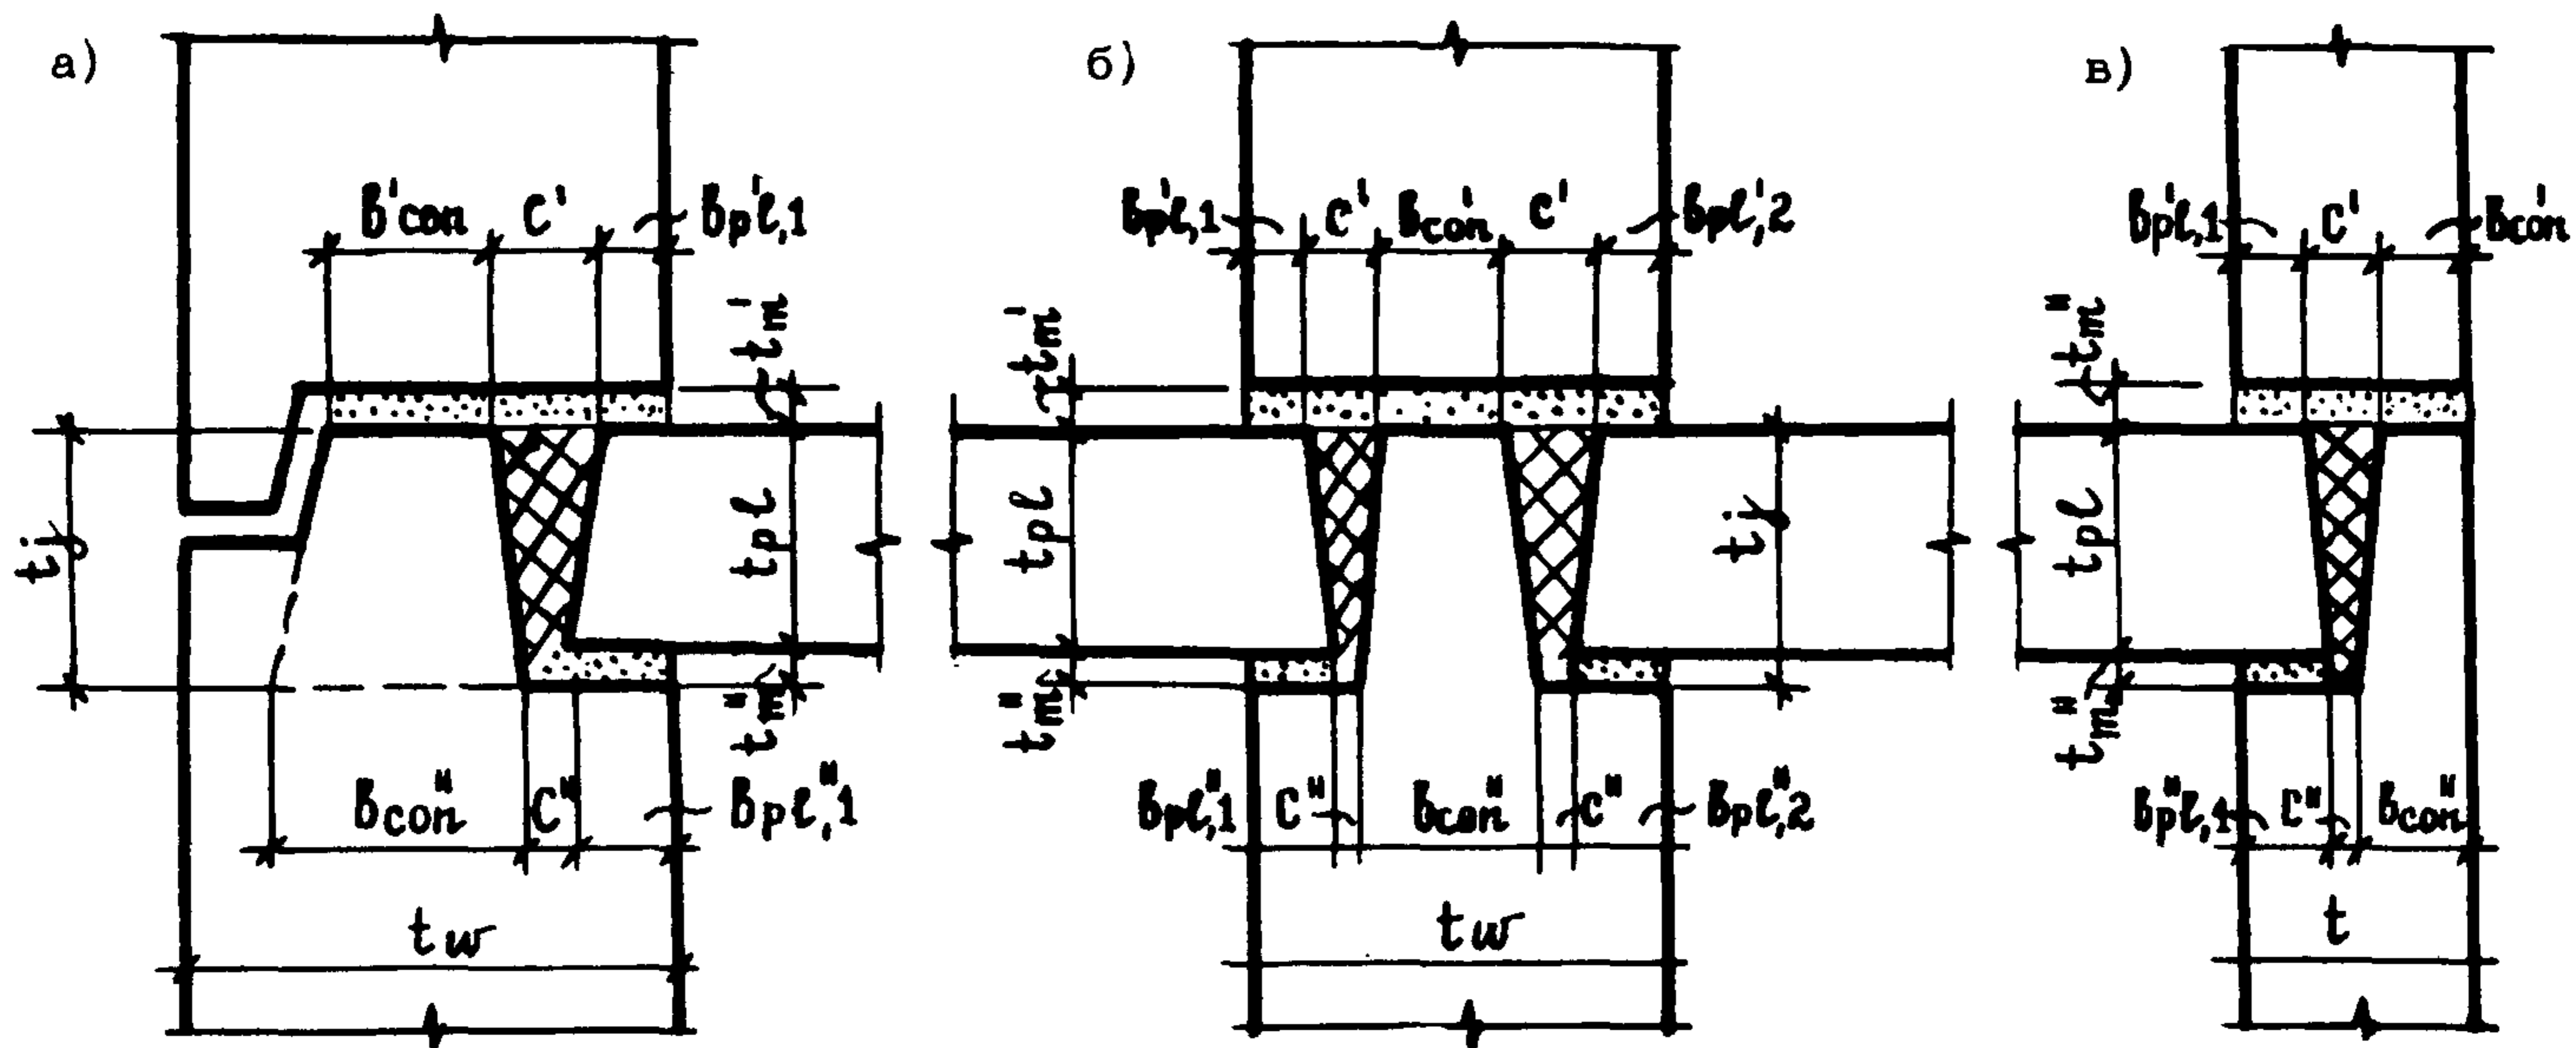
Контактно-платформенные стыки с односторонним (а, в) и двусторонним (б) опиранием плит перекрытий
